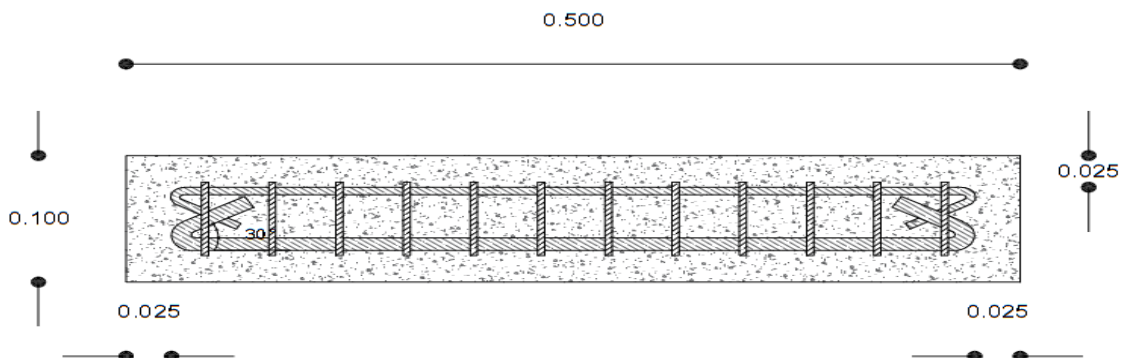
Diseño del armado transversal del acero de refuerzo.
